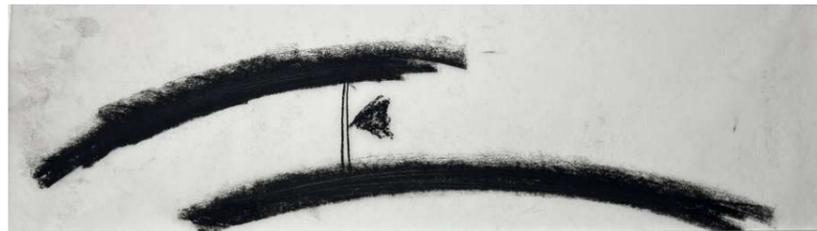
Konzeptskizze, überlappende Scheiben Grundriss, Autor, 2024
